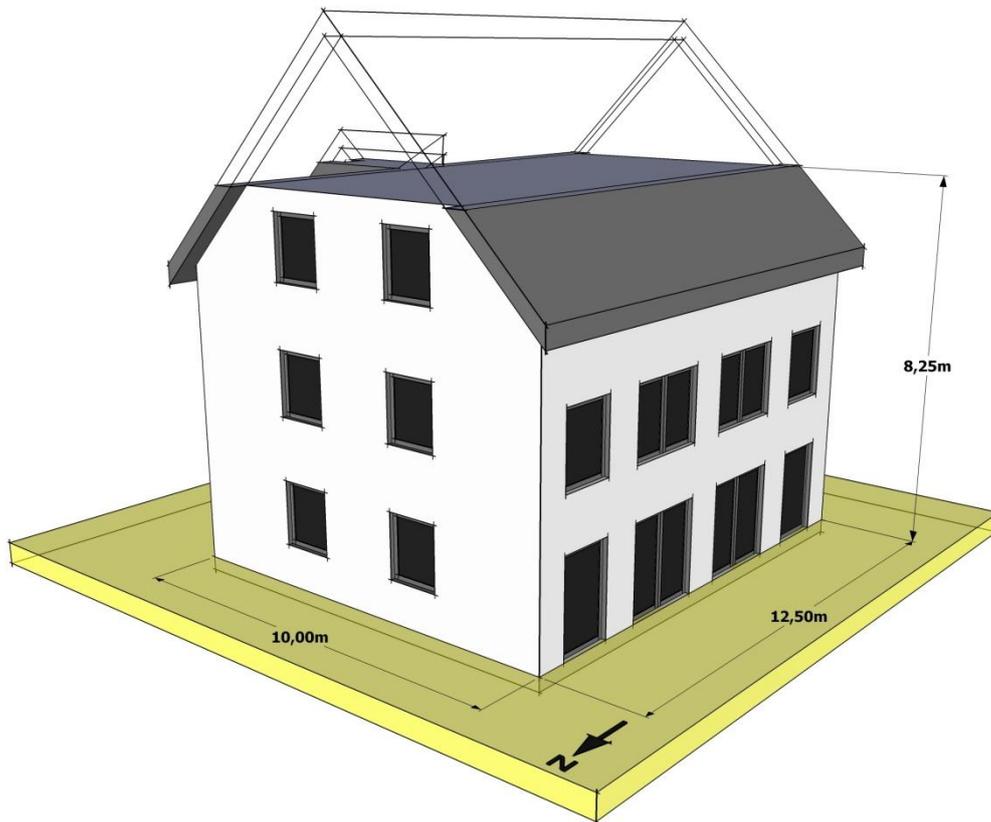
Einfamilienhaus groß – Ansicht Nord-West
